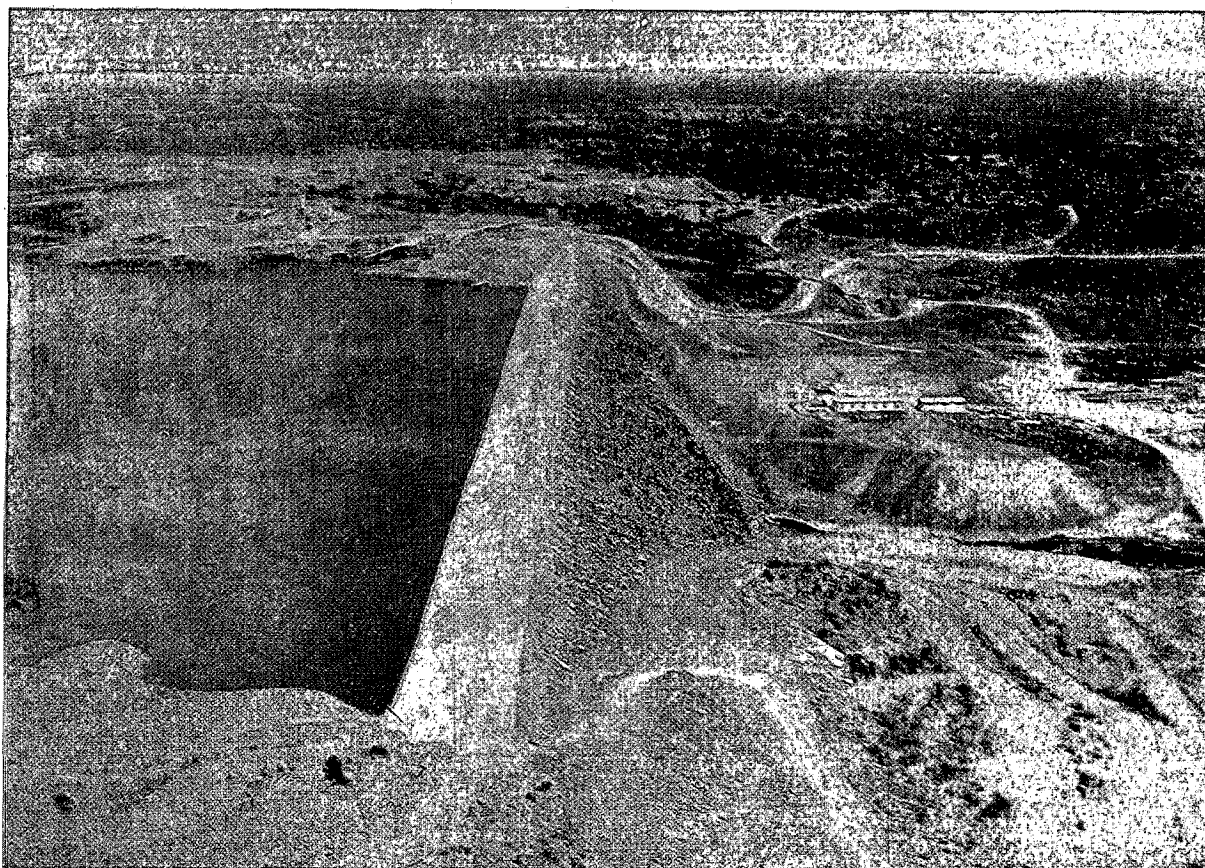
Presa del Piedras. Vista de la pantalla de hormigón armado sin juntas.
